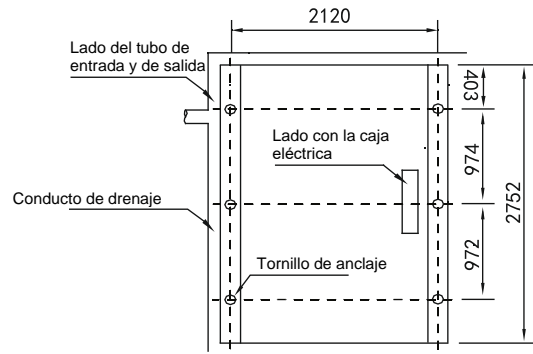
Dibujo de las dimensiones de instalación del SCV-1800EB - vista desde arriba
